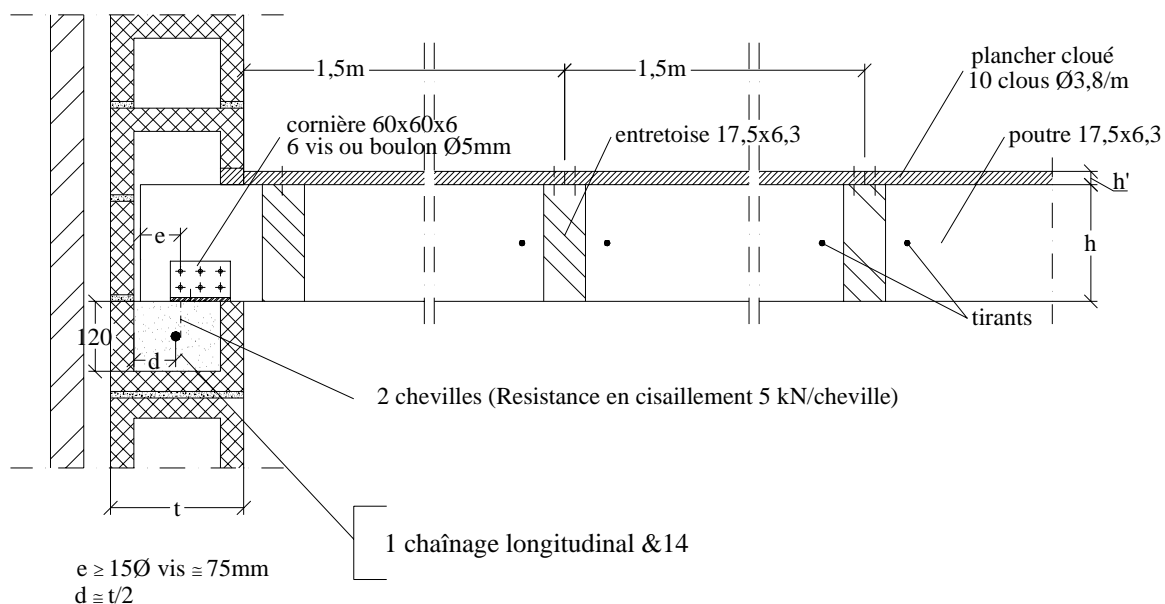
Liaison par ancrage entre poutre de plancher en bois et mur. Autre chaînage.
